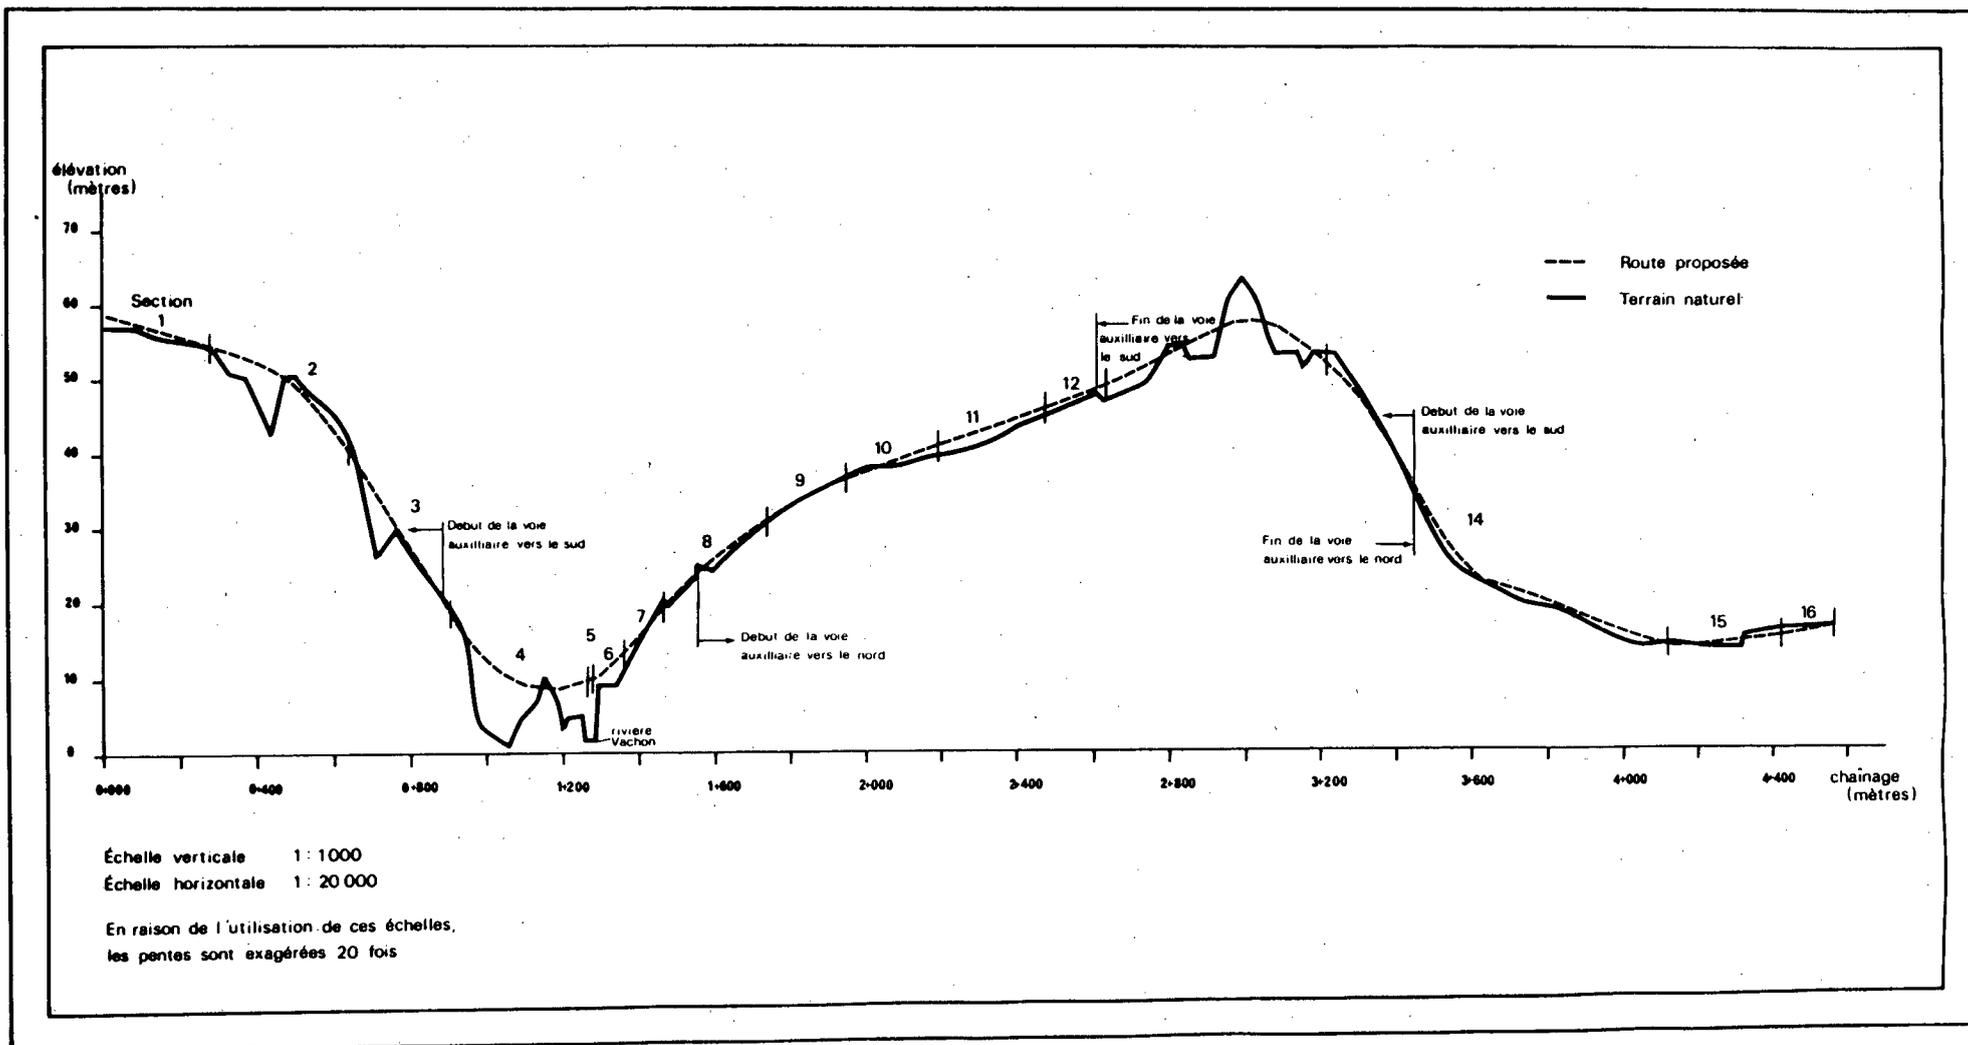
Plan en coupe longitudinale du nouveau tracé de route
